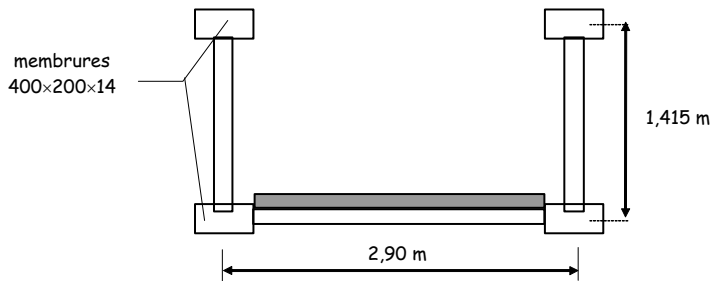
Section transversale de la passerelle avec membrures en tôles de 14mm et hauteur de 1,415m
